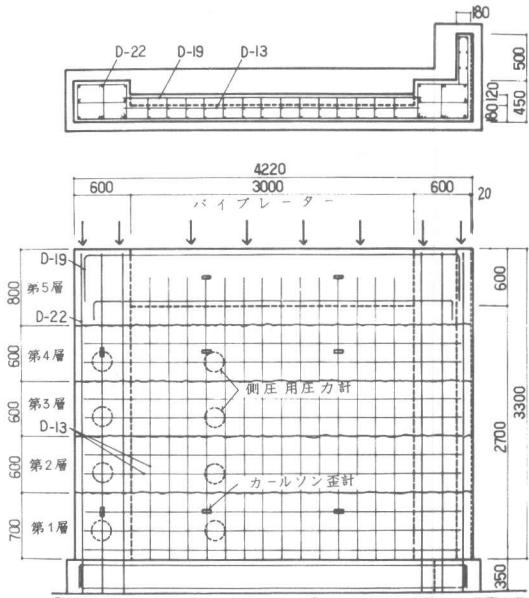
RC造の実大試験体、コンクリートの打込み方法および測圧計とカールソン歪計の配置図
